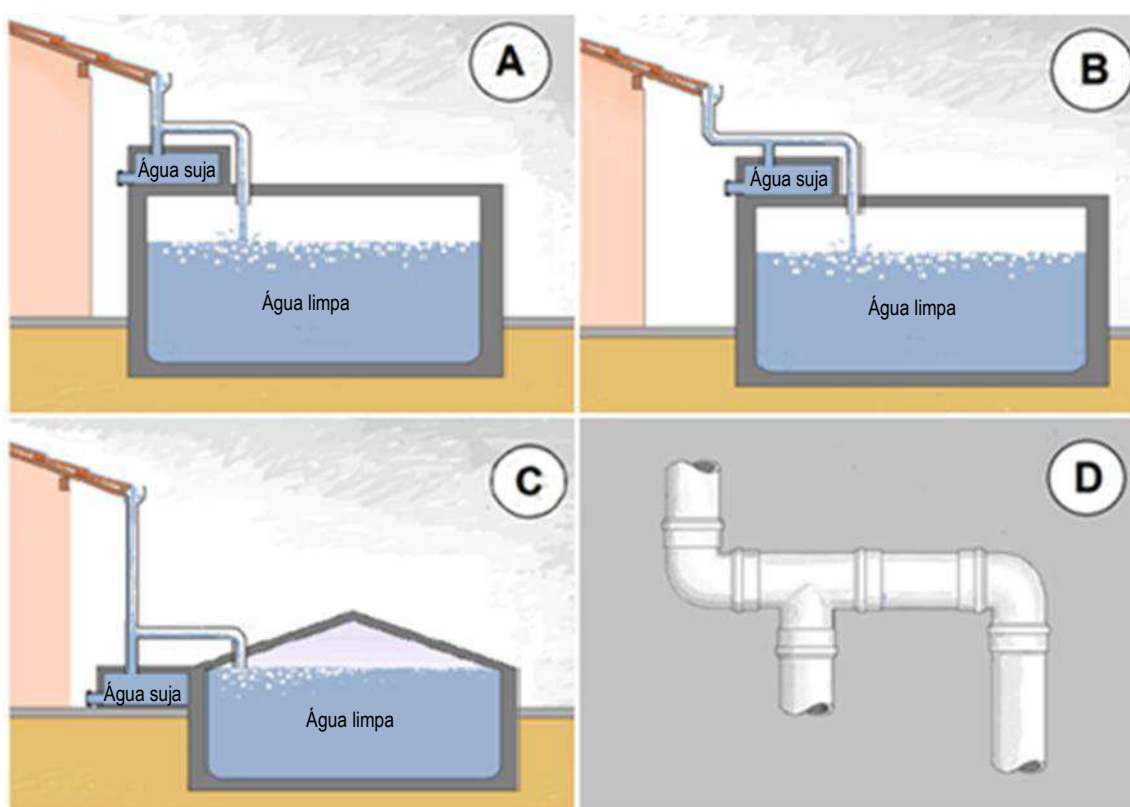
Três distintos layouts de dispositivos de desvio automático de primeiros fluxos construídos em alvenaria (A, B e C) e sua montagem em tubos de PVC rígido e respectivas conexões (D).
